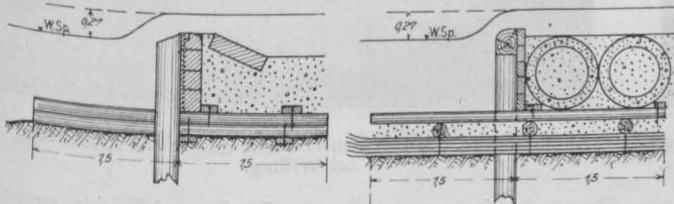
Ansicht und Grundriß einer Betonbalkenschwelle.
